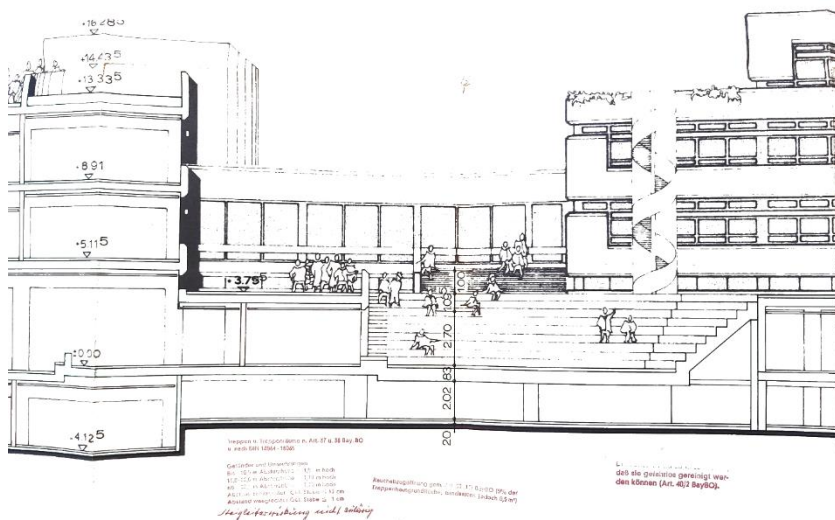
Abb. L: Schnitt durch das Atrium, Planungsstand Genehmigungsplanung 1972 (Eingabeplanung LBK, Schnitt D-D Klassentrakt, M1:100)
